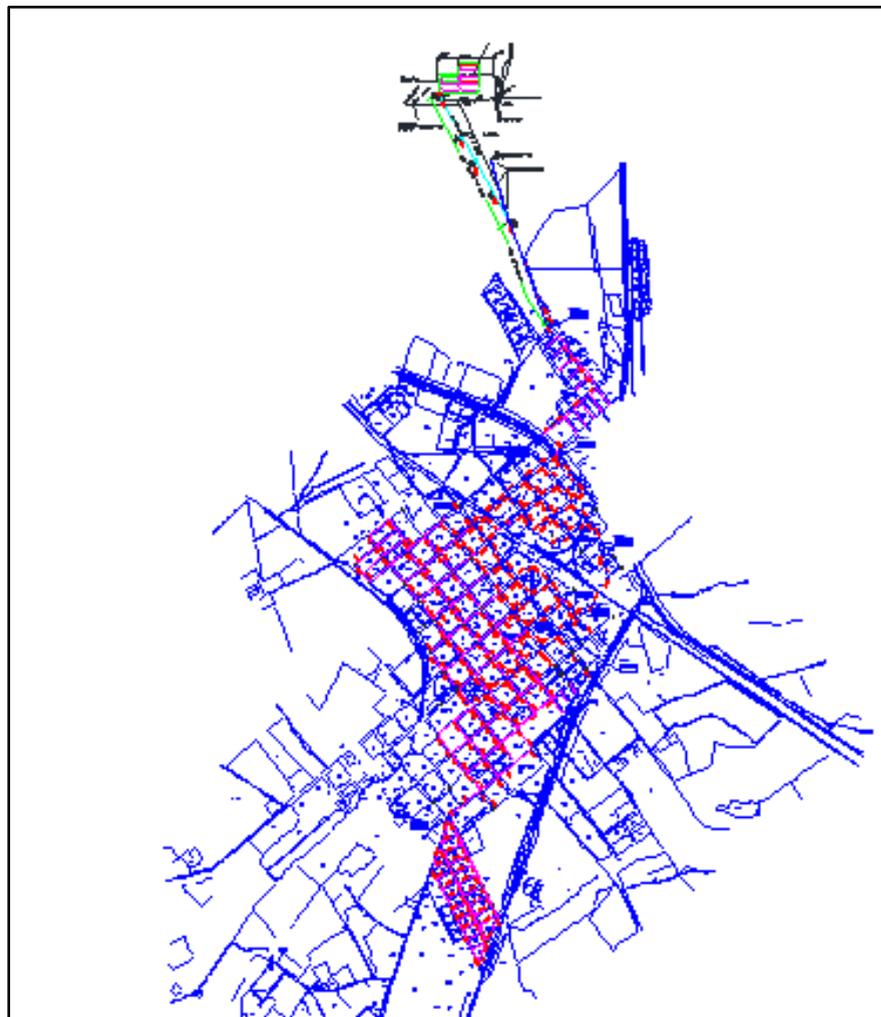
Plano Ciudad de Chamental con ubicación planta de tratamiento existente.
